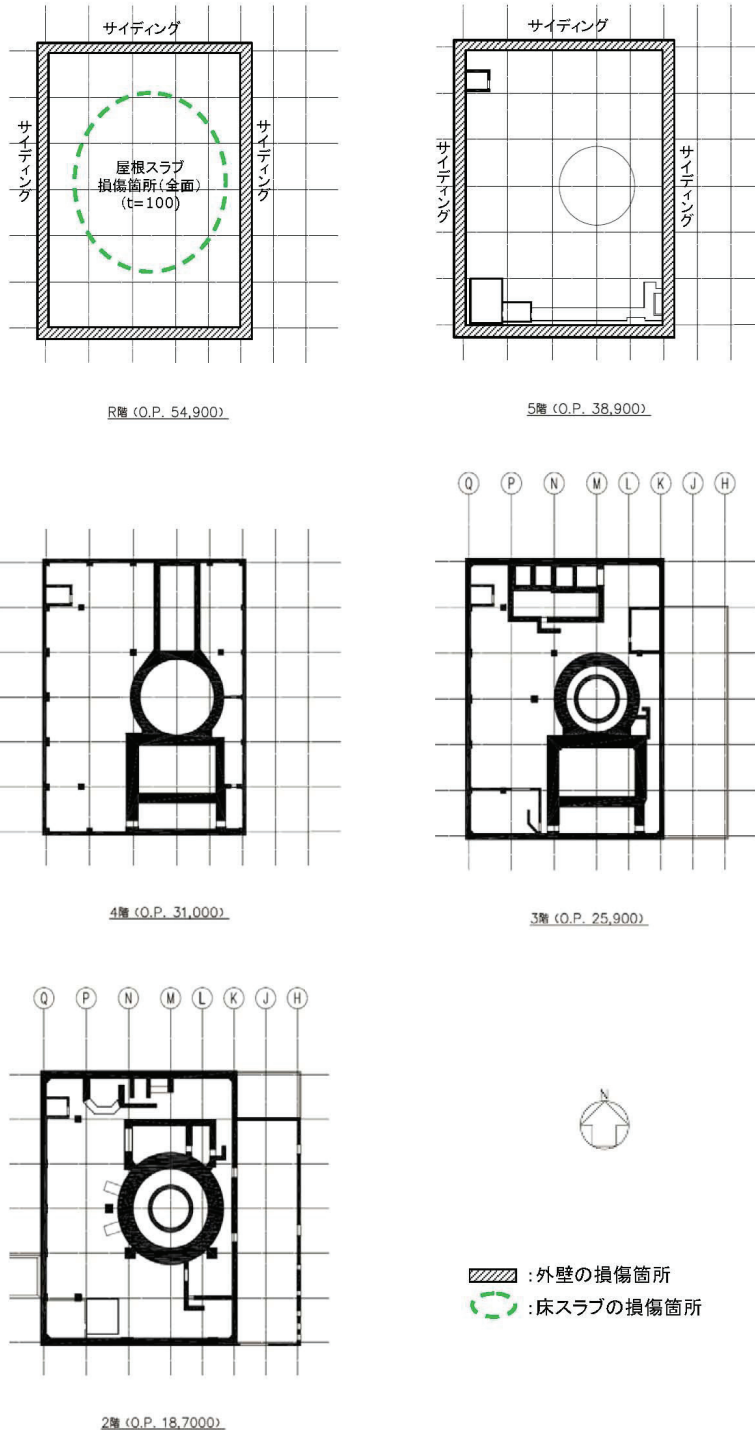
1号機原子炉建屋の損傷状況(平面図)
